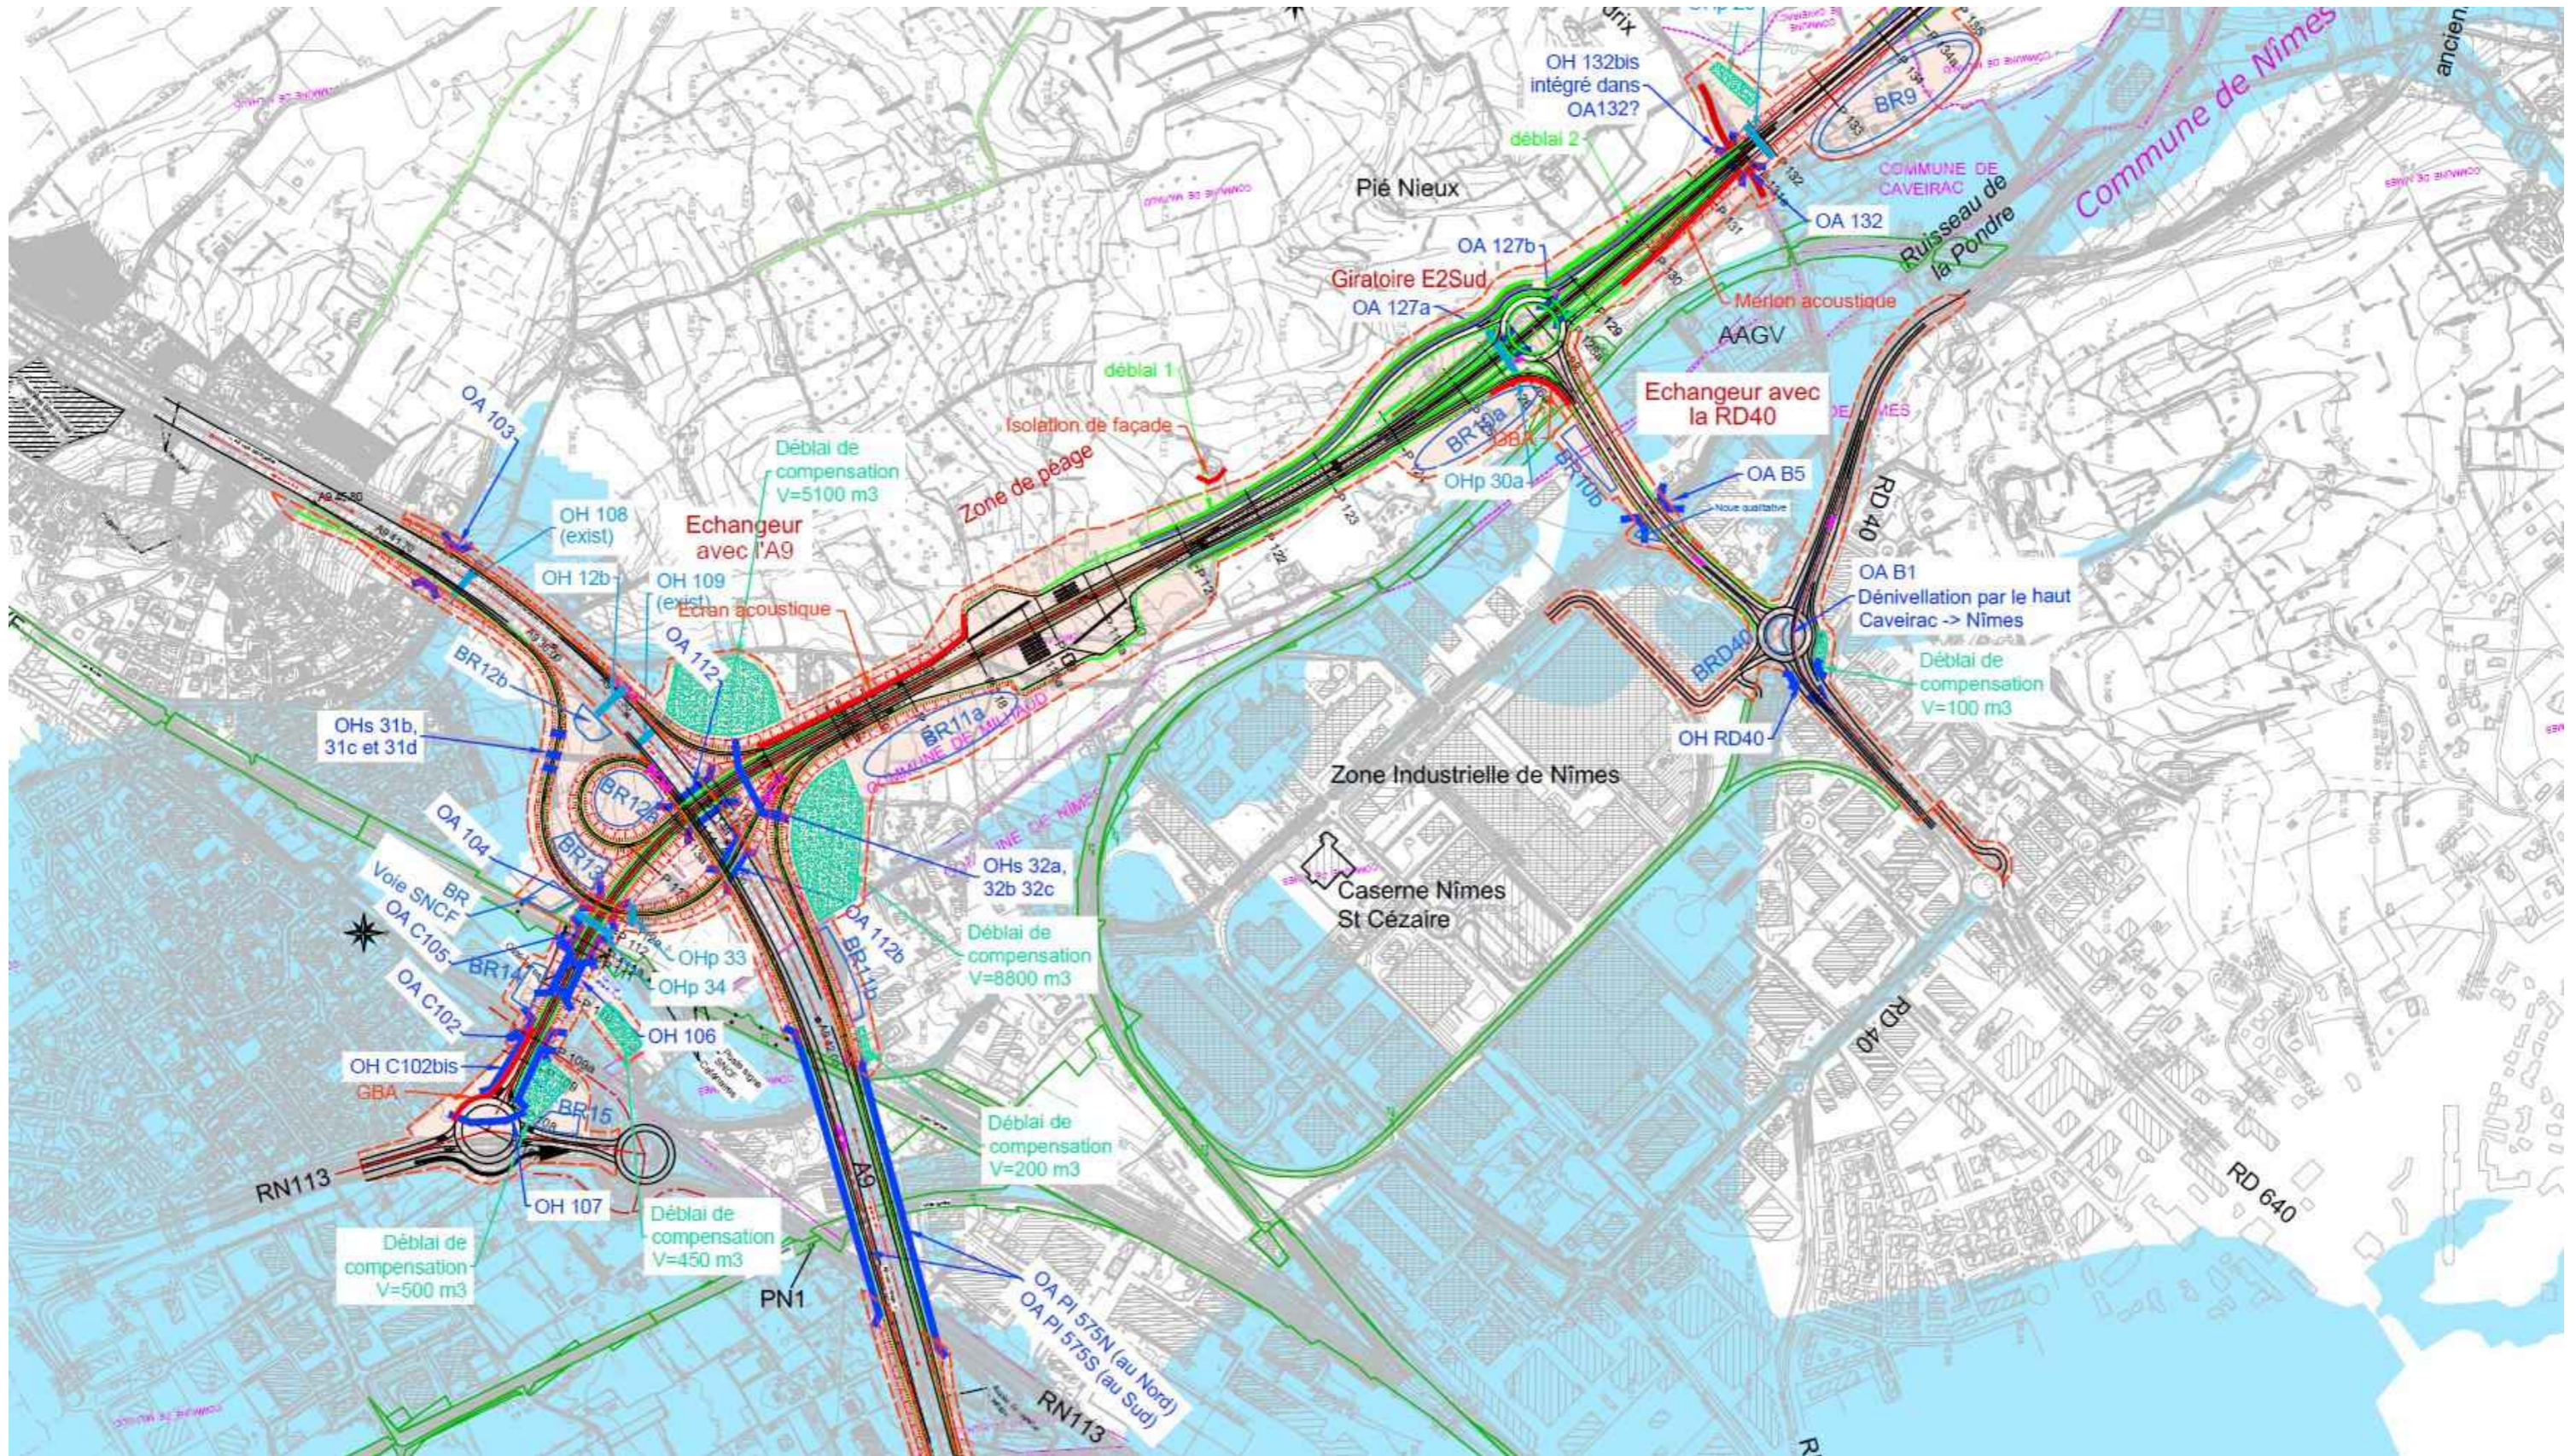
plan de masse du projet – Secteur Sud, barreau et raccordement à l'A9 - 4/4 (Source : Présents, juin 2021)
